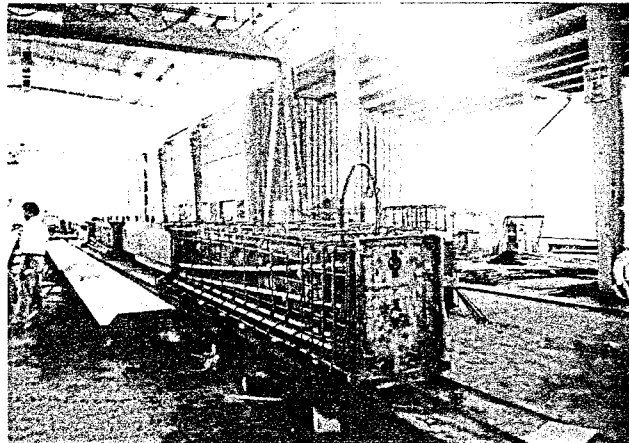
Sistem Penulangan Gelagar Beton Pracetak
